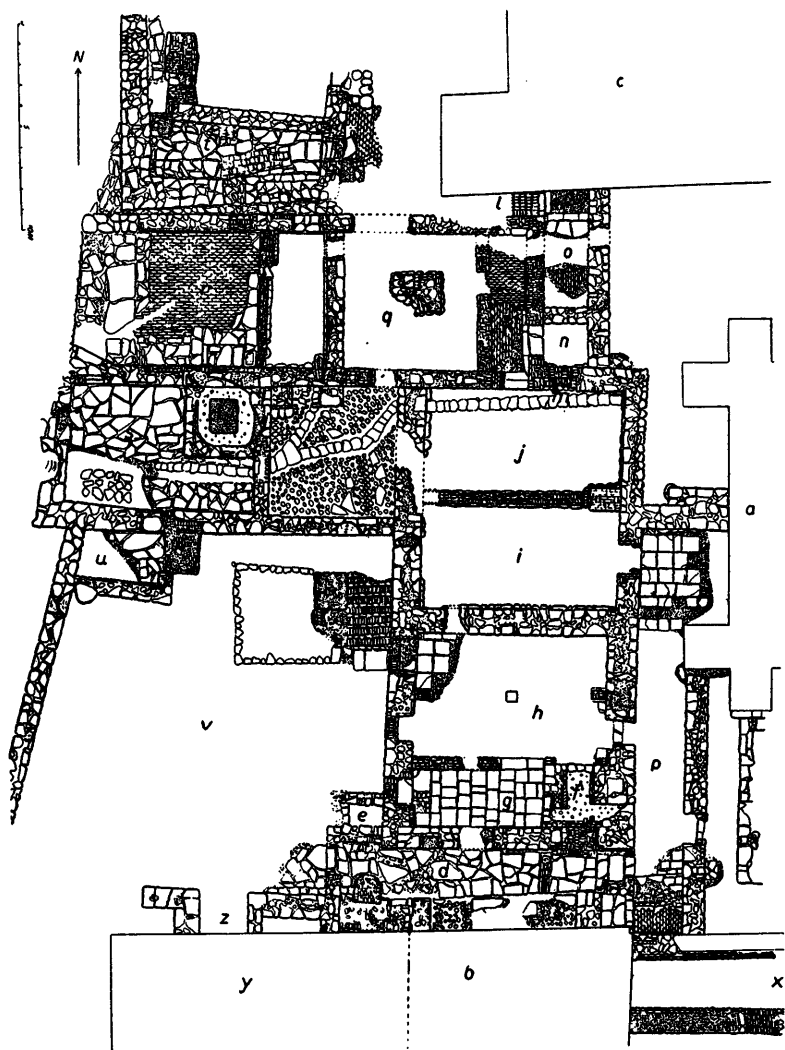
Grundriss der 1926 u. 1927 freigelegten Räume hinter dem Westchor der Klosterkirche zu Vadstena. Nach B. Berthelson (Fornvännen 1928).
